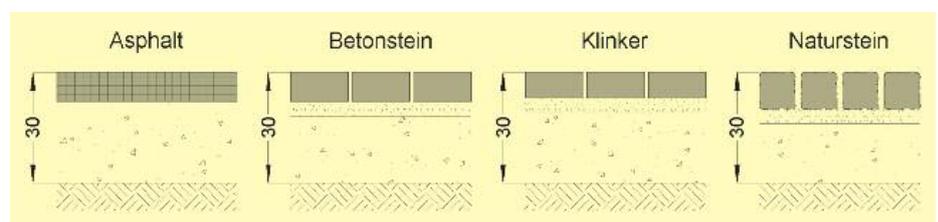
Beispielkonstruktionen „Oberbau Gehweg“
